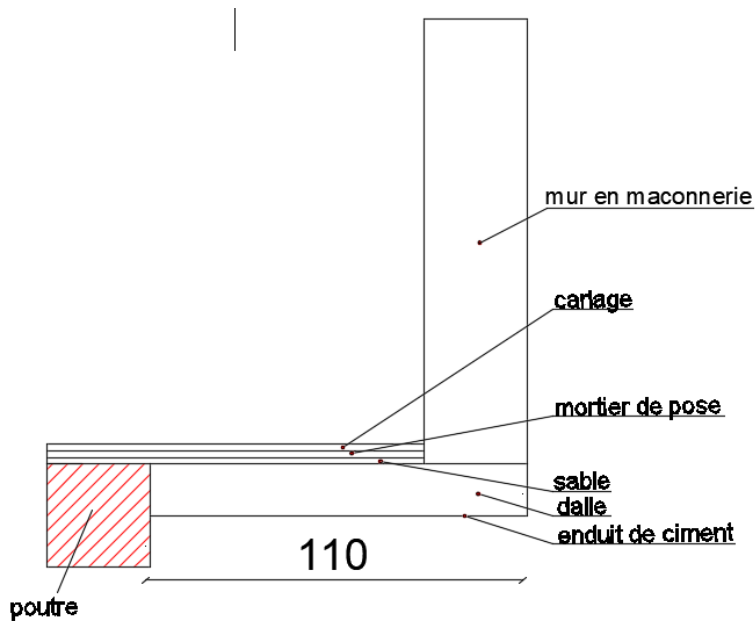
Dimensions et schéma statique du balcon
